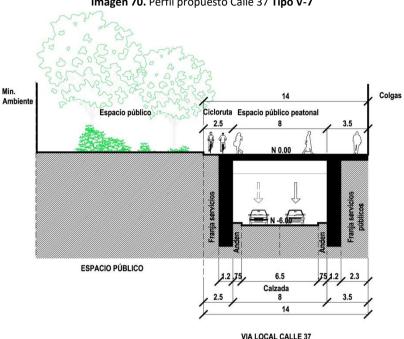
Perfil propuesto Calle 37 Tipo V-7
